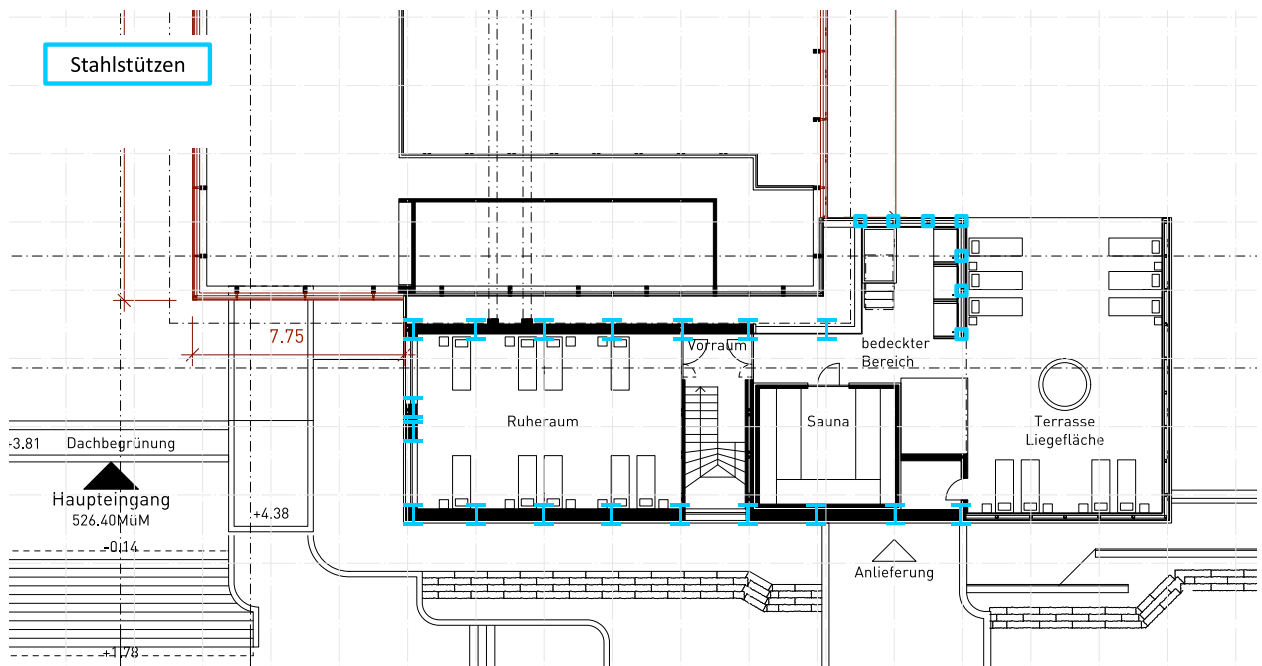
Modellerte tragende Elemente Sauna im 2. Obergeschoss
